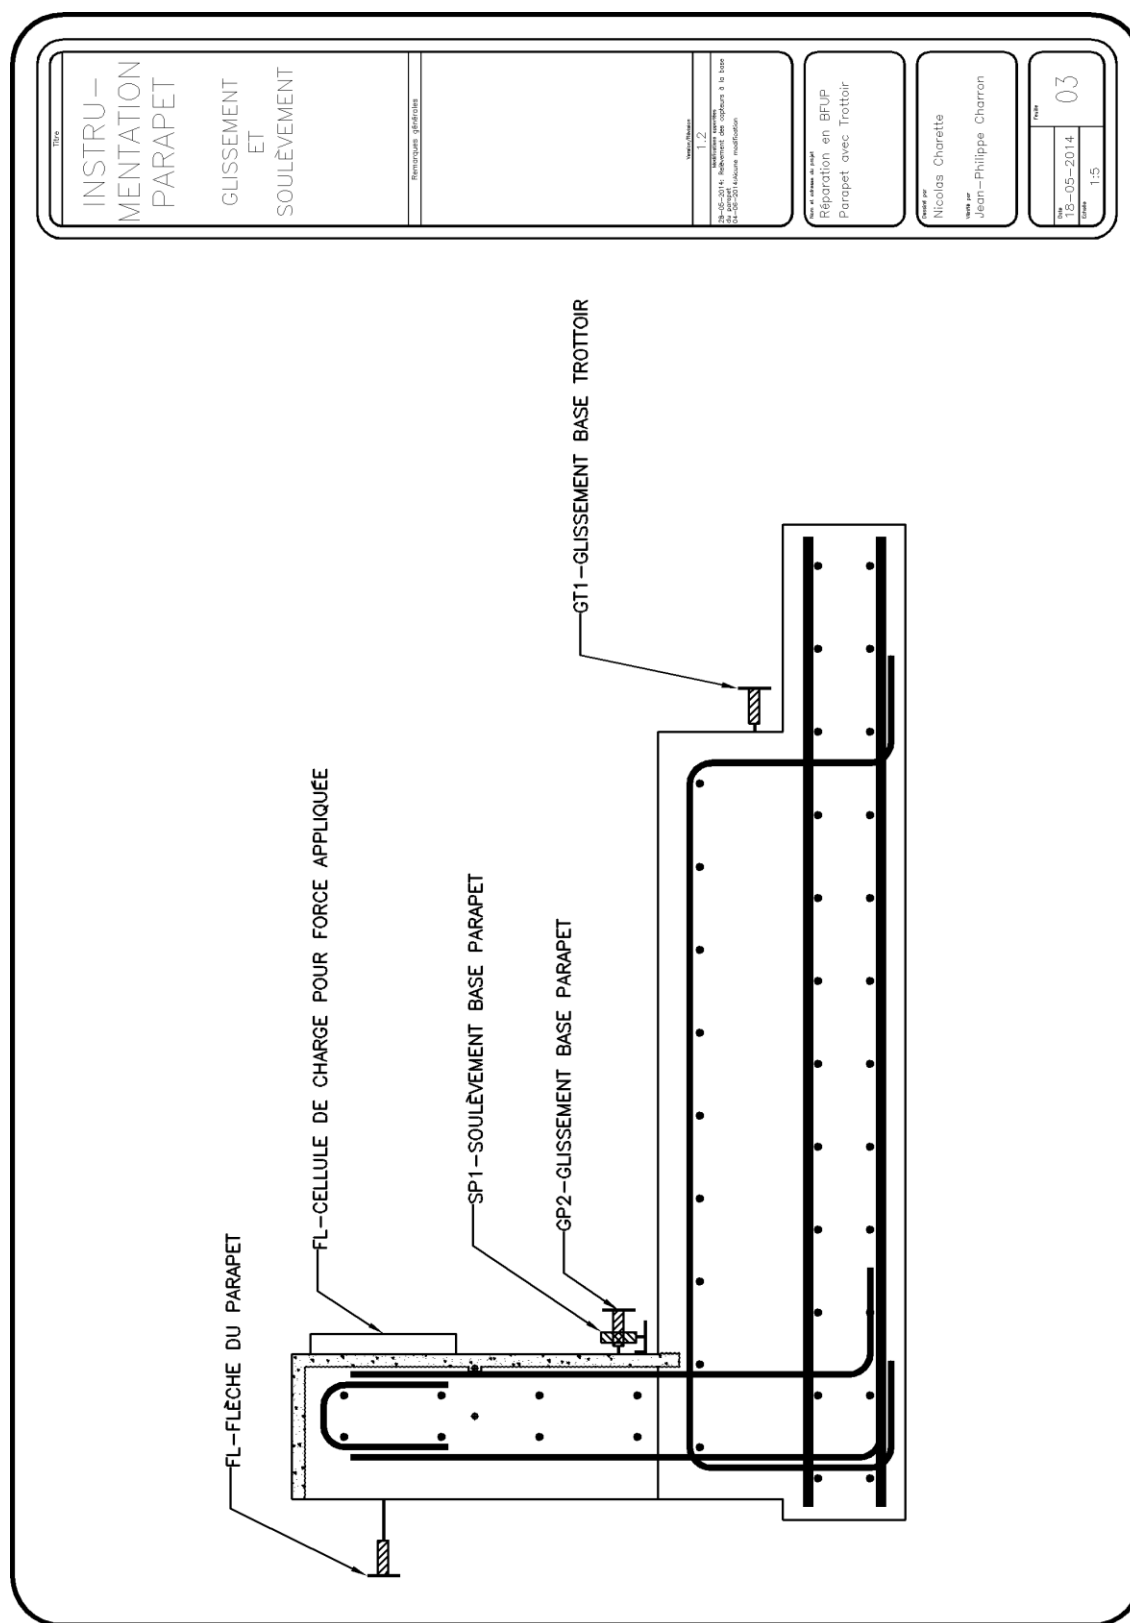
Plan d'instrumentation pour glissement et soulèvement
